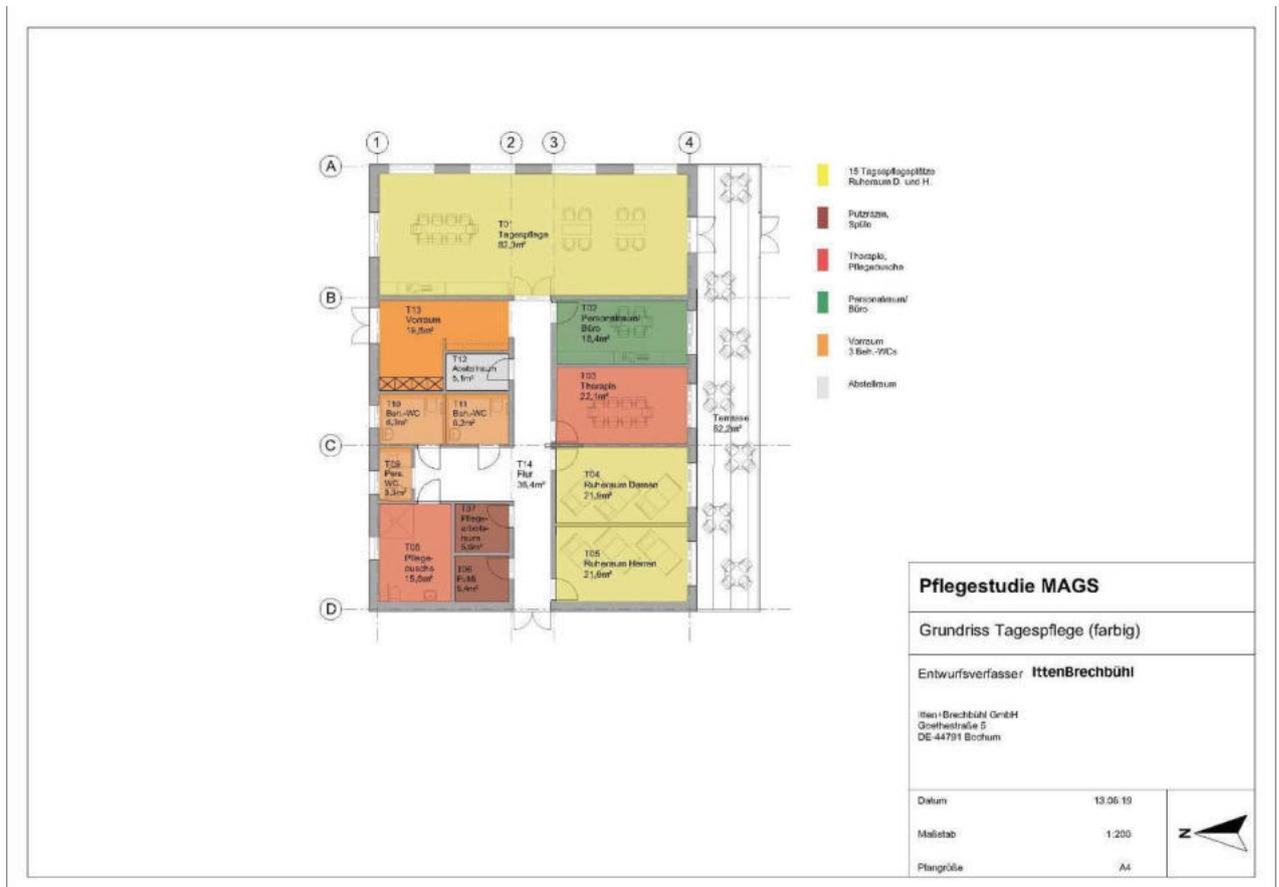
Grundriss TS; Quelle: Itten + Brechtbühl GmbH
